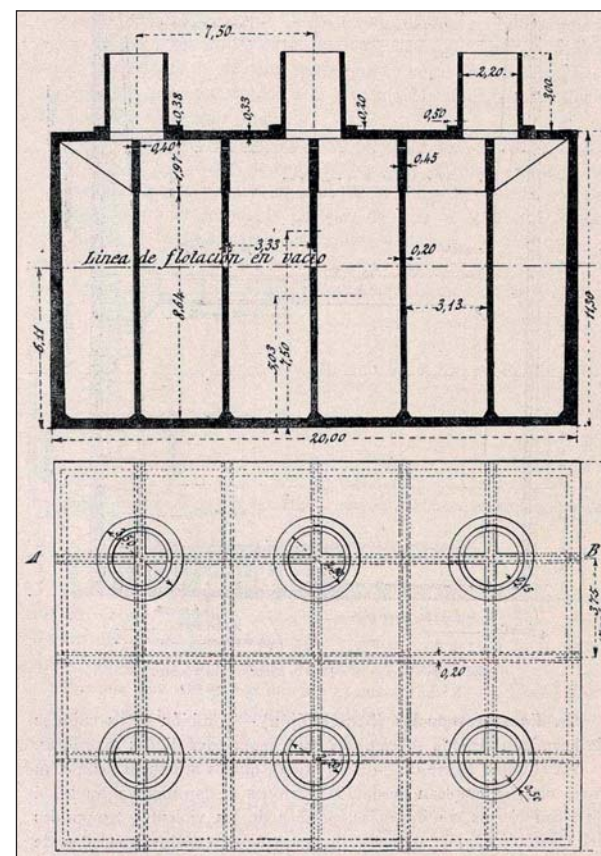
Plano de sección y planta de un cajón de hormigón del Dique Norte del Puerto de El Musel, Gijón (RIBERA 1930:238). Se aprecian las 24 celdas y las 6 chimeneas.
